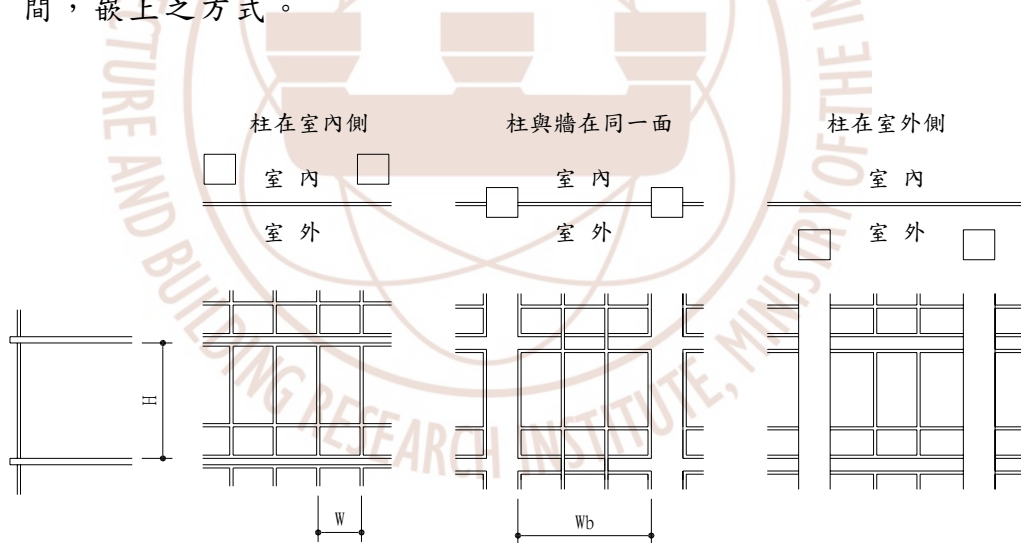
嵌板型式 (Window Wall) 帷幕牆
